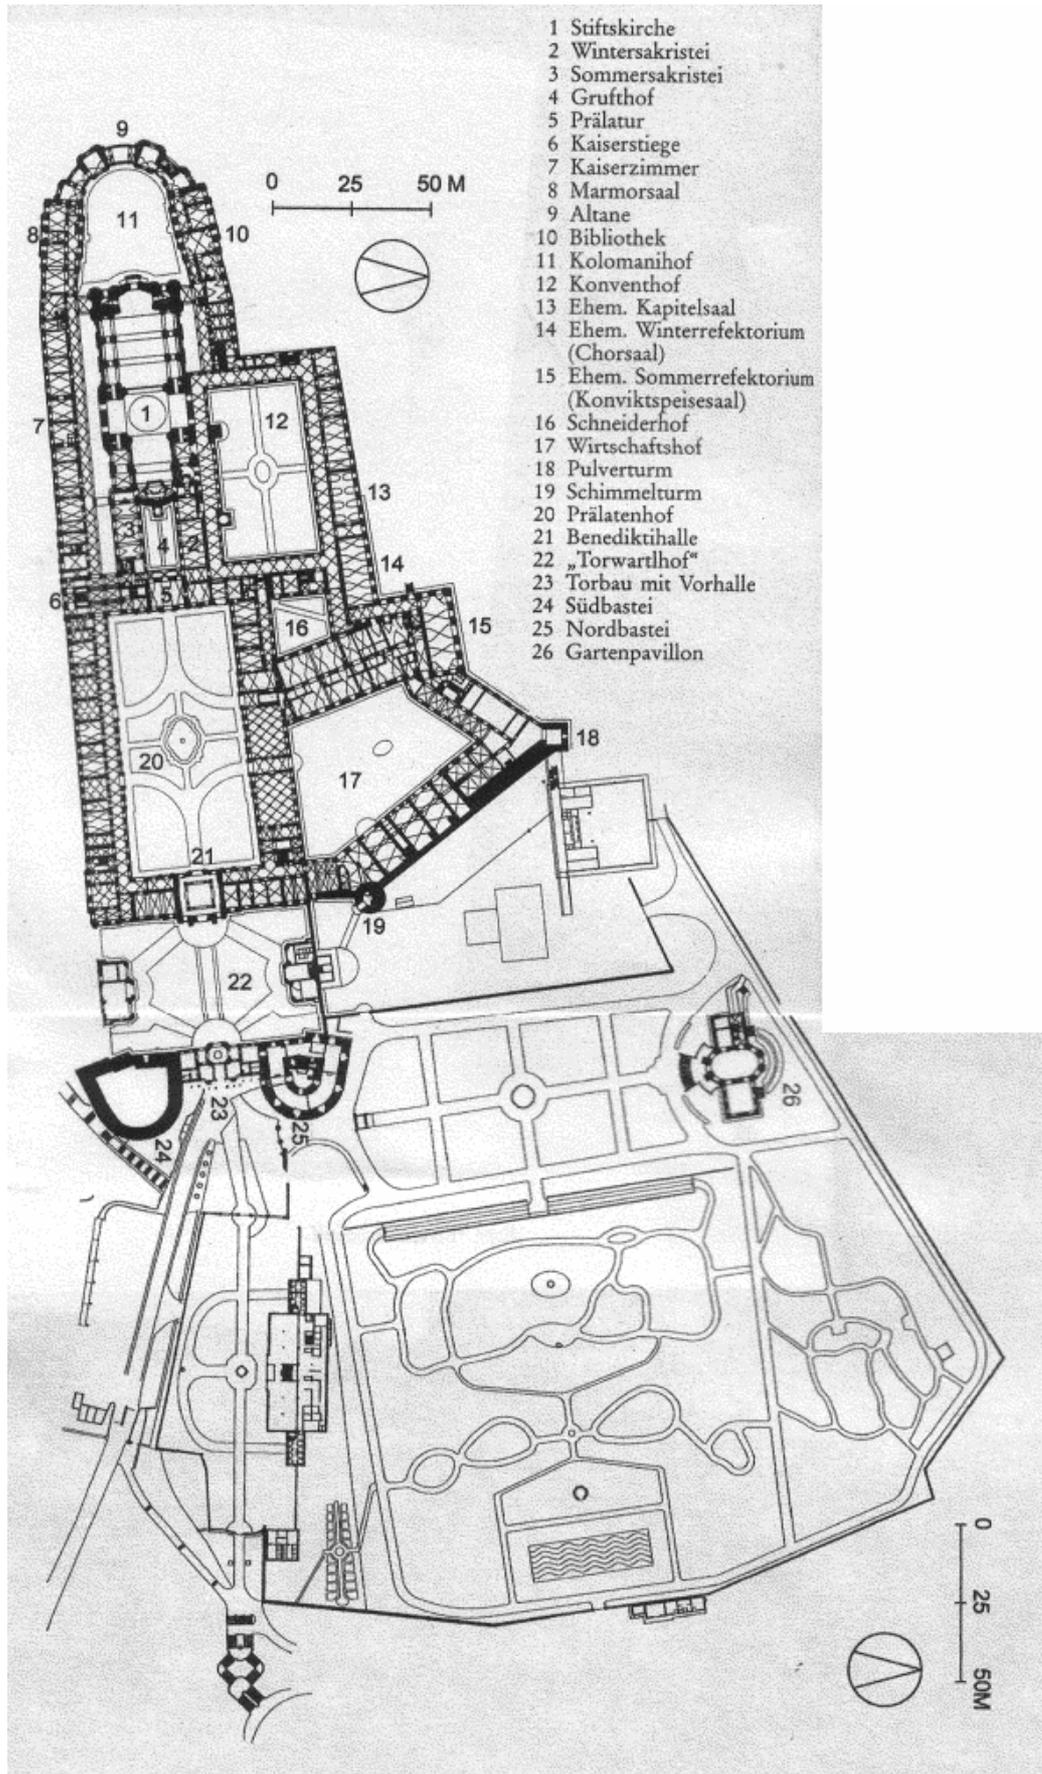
Melk, Benediktinerstift Melk, Grundriss
